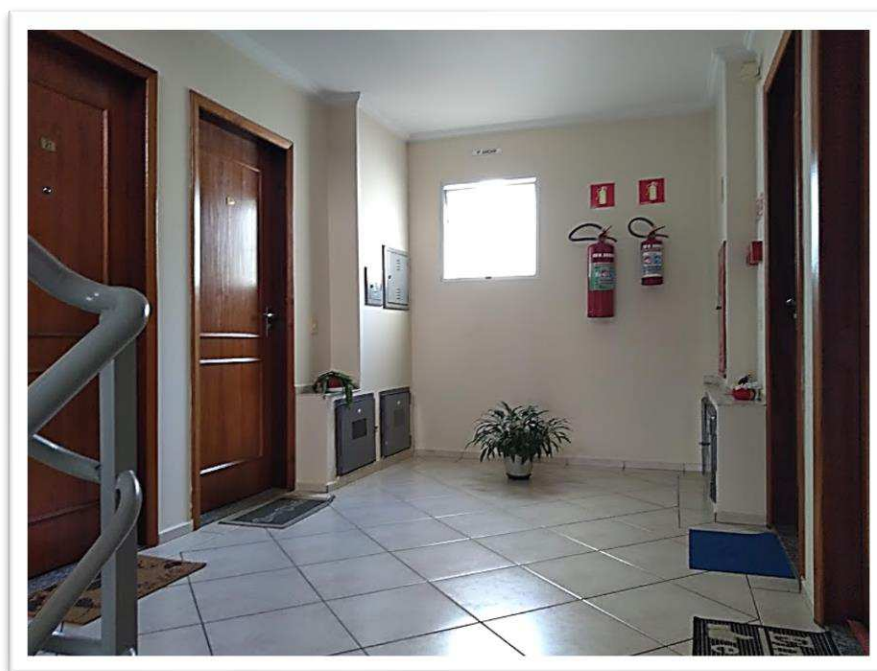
Aspectos dos acabamentos do hall do 1º pavimento.
